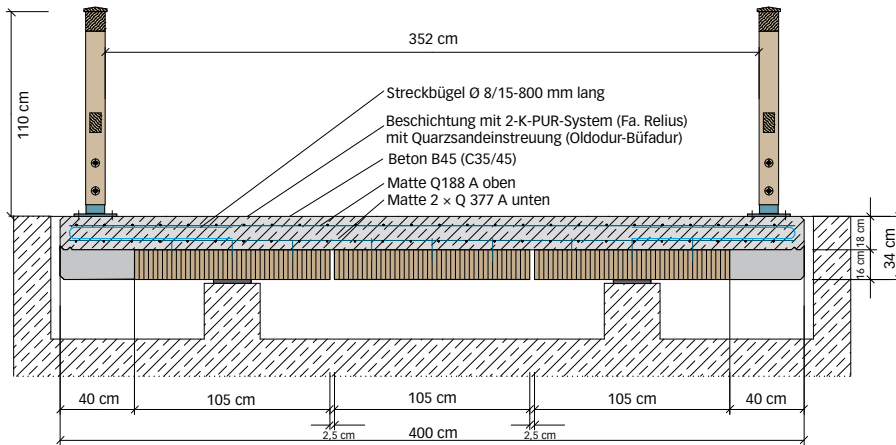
Querschnitt der Holz-Beton-Verbundbrücke in Kayl (aus [1]).
